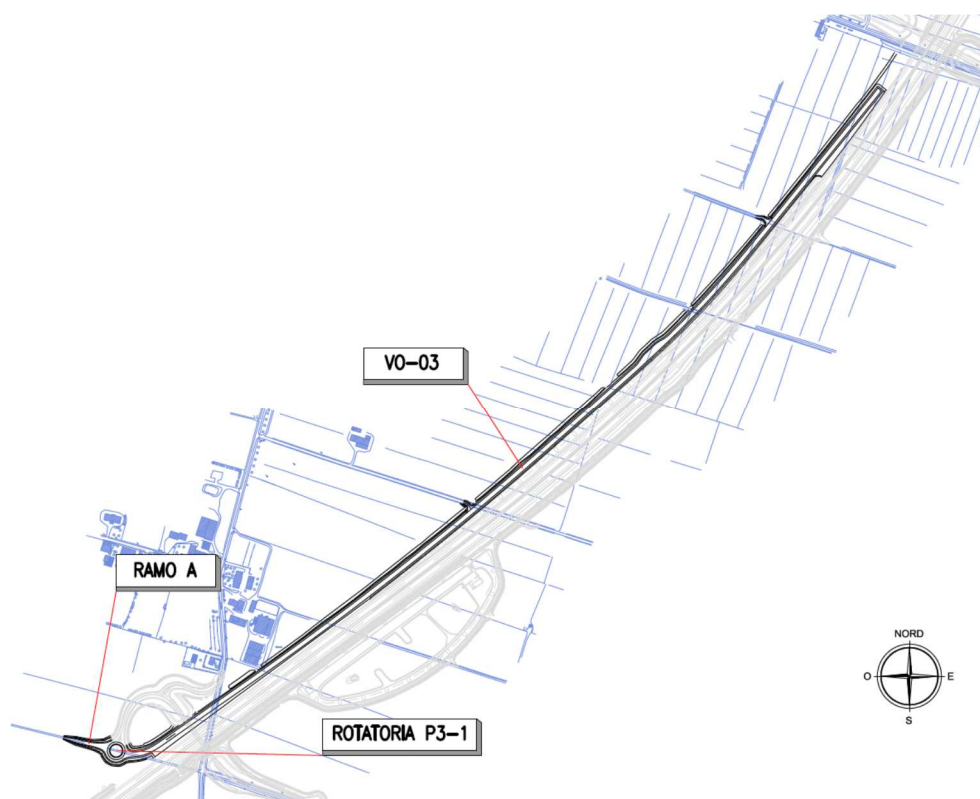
Key plan - Raccordo S.P.10 Autostazione TreCasali-Terre Verdiane (VO03)
